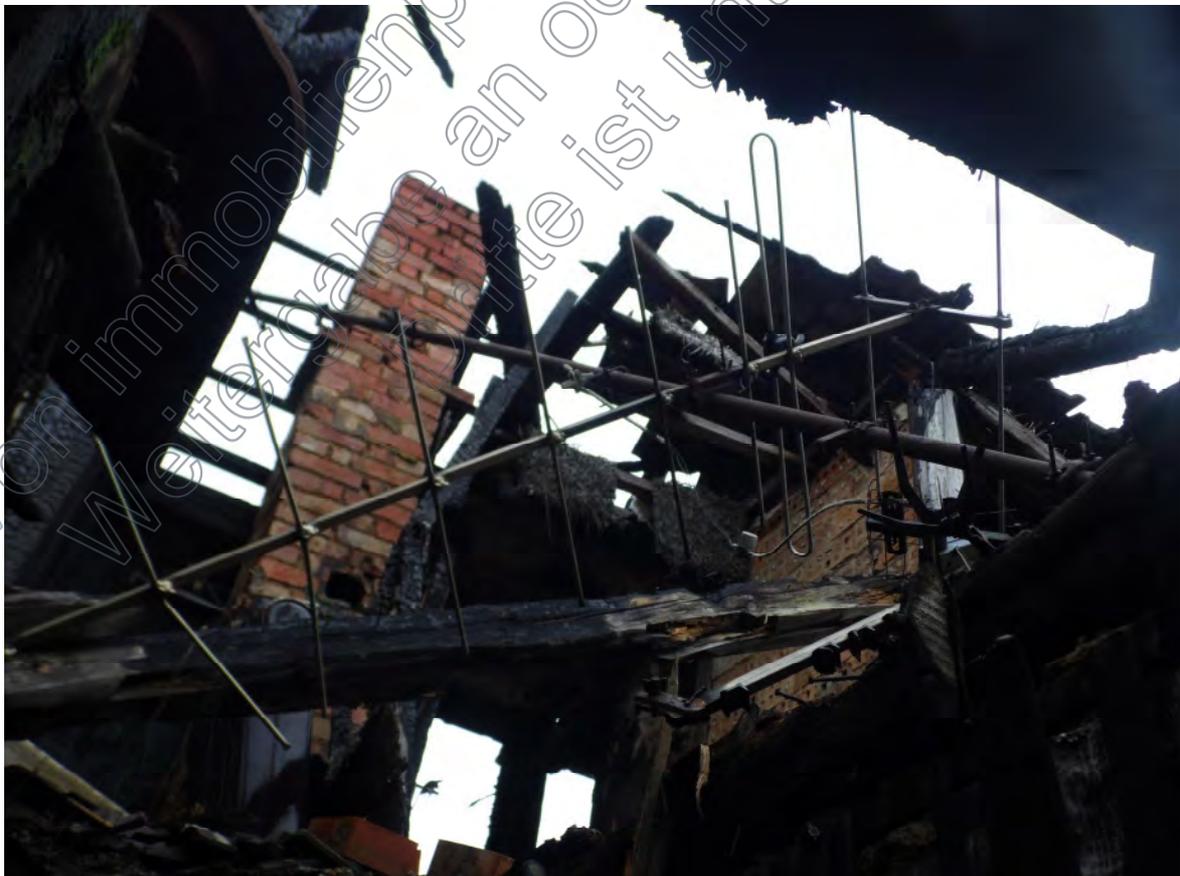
Ausschnitt – völlig zerstörtes Dachgeschoss
